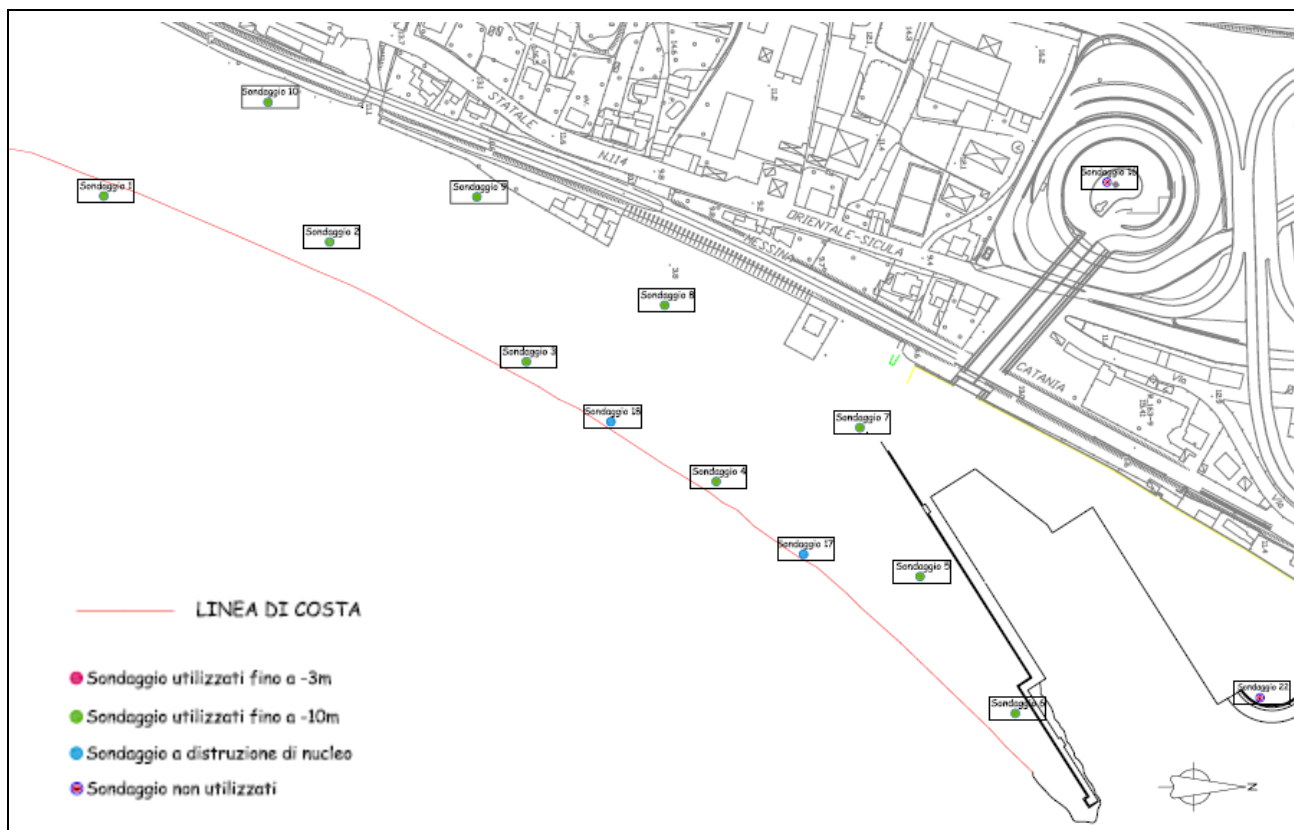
Estratto planimetria con ubicazione dei sondaggi nell'area di dragaggio
